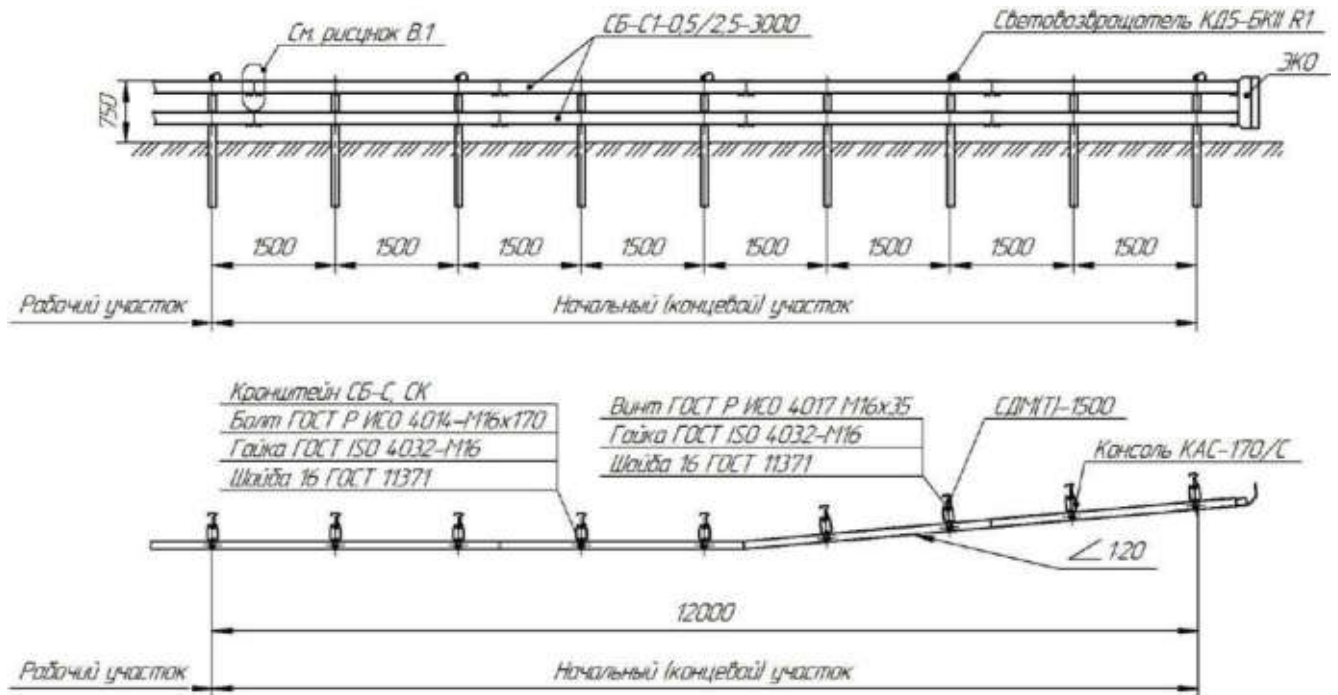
Схема сборки конструкции №5 (Изм. №1)
